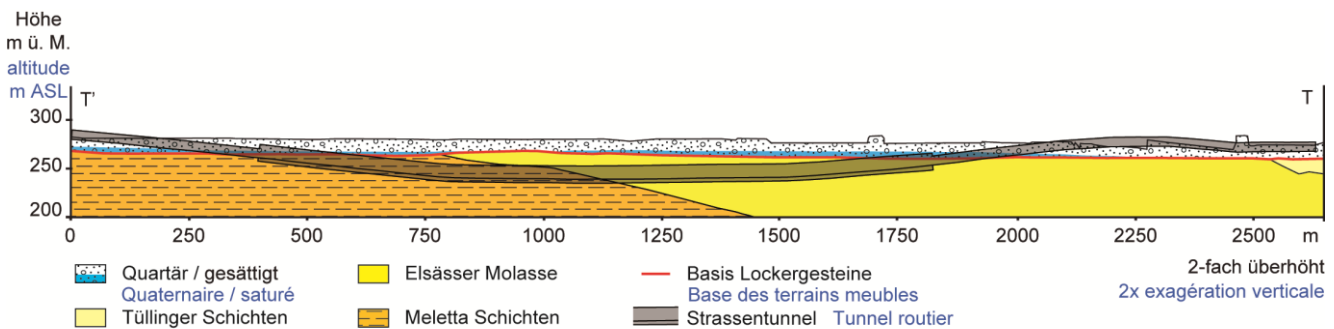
3 Tunnellängsprofil (2-fach überhöht)
